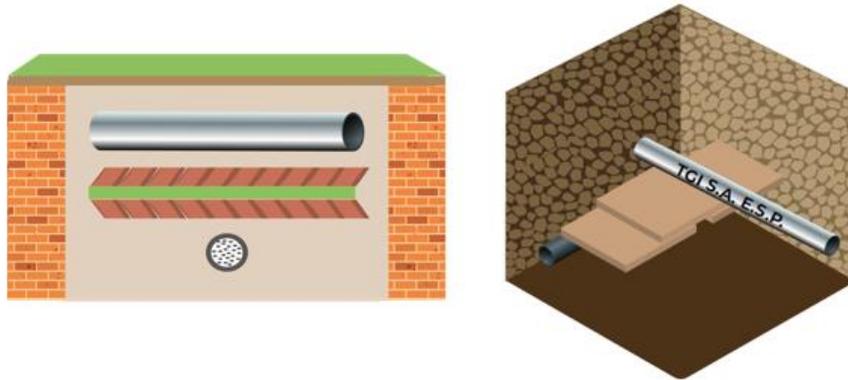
Protección con baldosas, losetas o placas de cemento-cruce.
